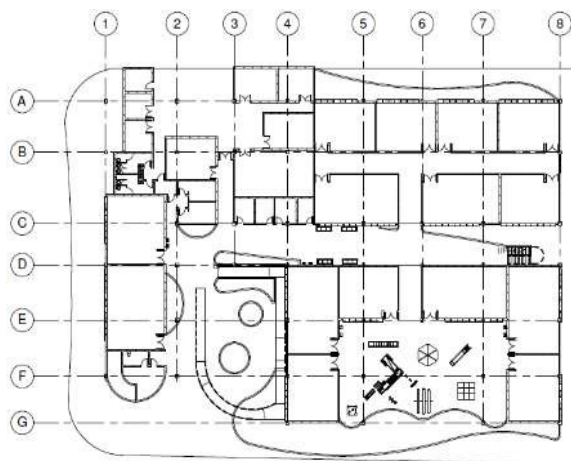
Planta baja Centro Educacional Inicial. (2018)
